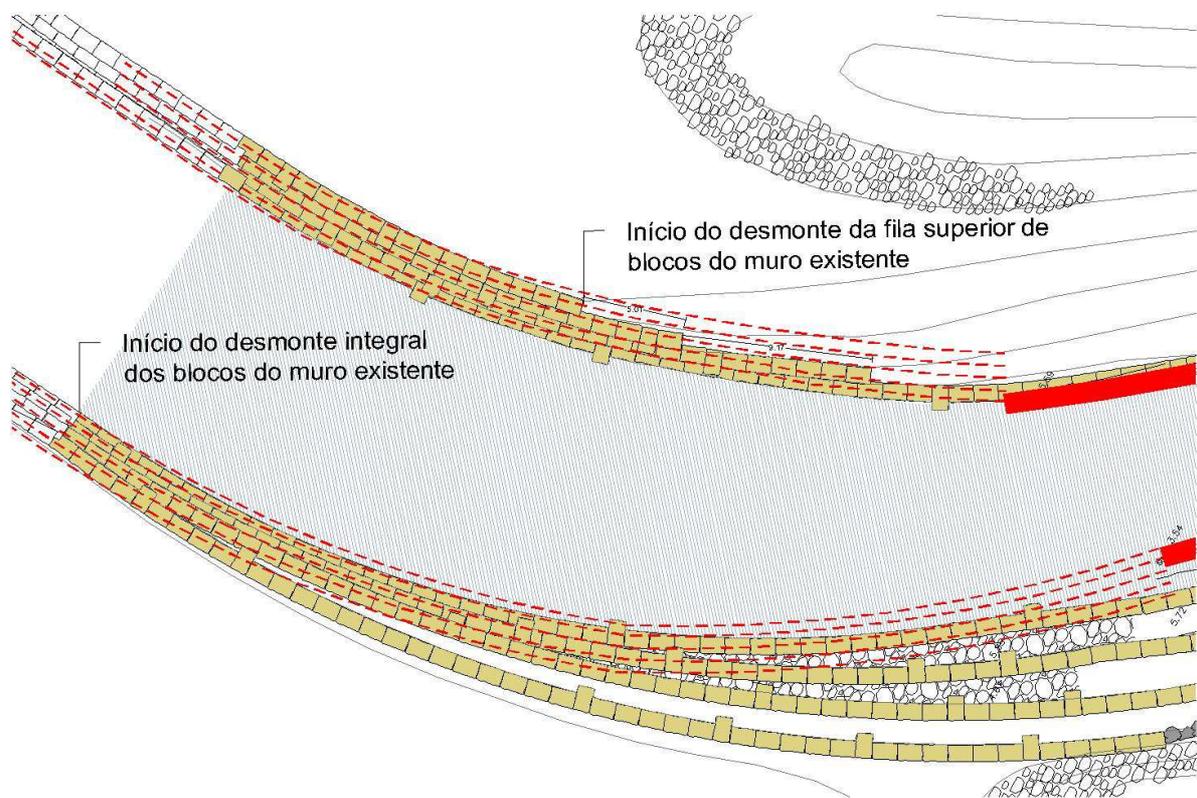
Articulação do traçado do muro de blocos de pedra de calcário existente (vermelho)
